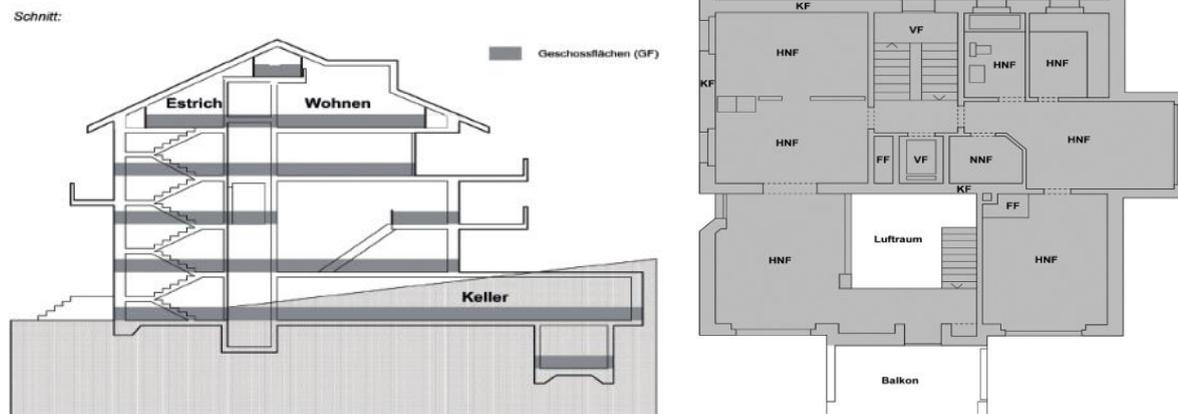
Figur 8.2 Geschossflächenziffer, IVHB
